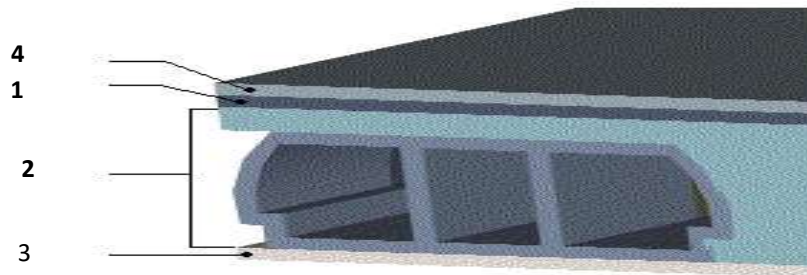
Coupe transversale d'un plancher à corps creux d'étage courant
